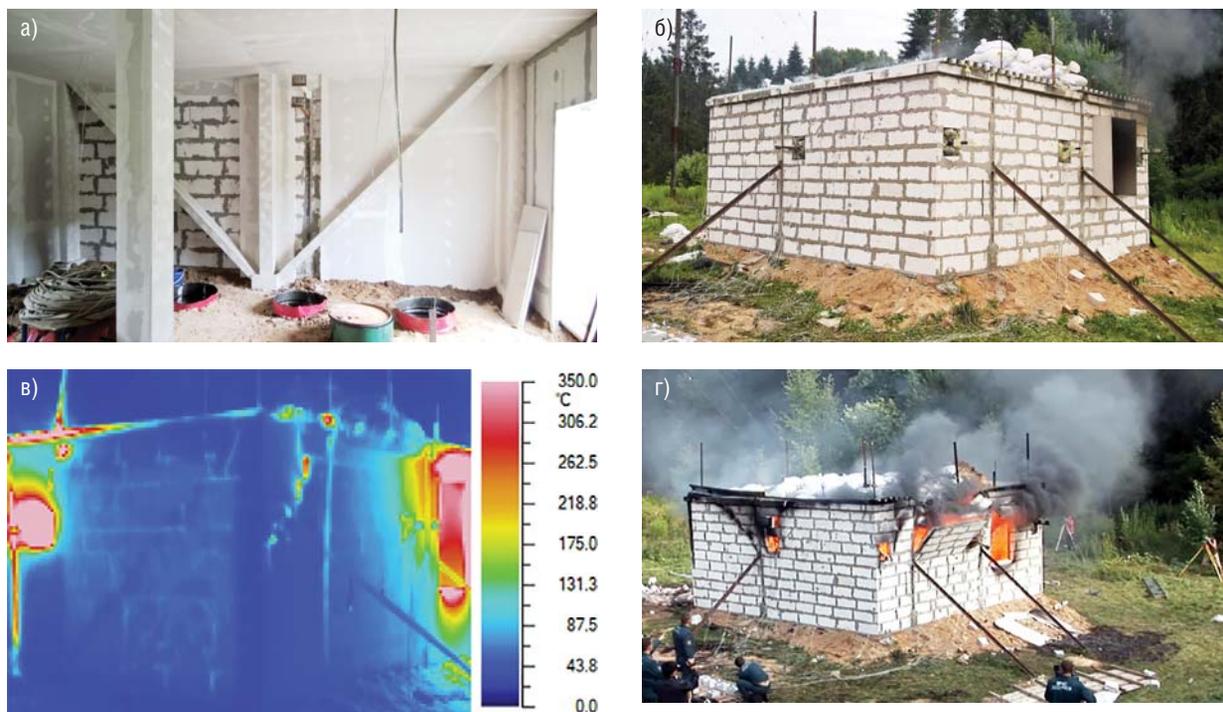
Общий вид экспериментального фрагмента и натуральных огневых испытаний: а) изнутри до начала испытаний; б) в начале испытаний; в) в ходе испытаний (тепловизор); г) в момент разрушения стального каркаса
